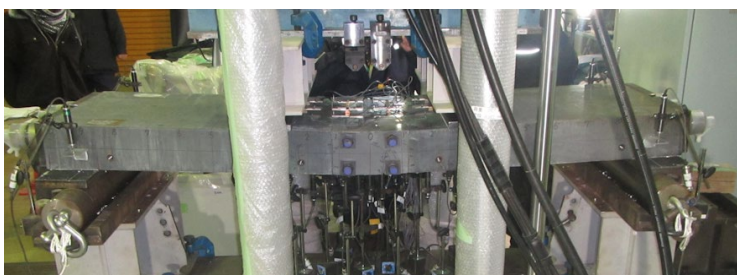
接合部を含む繊維補強コンクリート床版の曲げ試験
